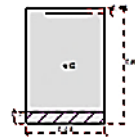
Ferrailage de la poutre (45x65) sur appui
